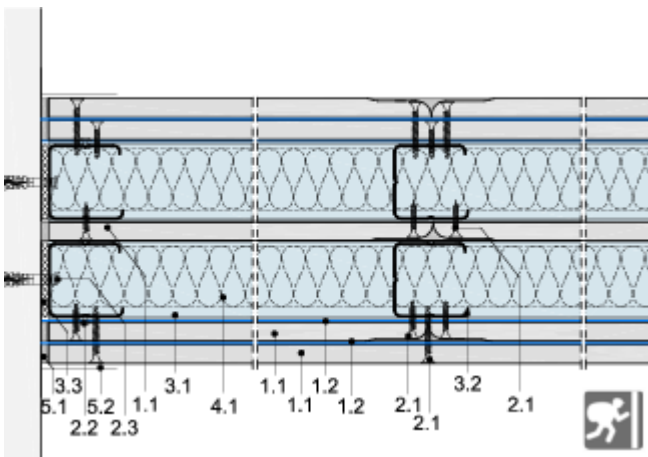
Wandanschluss Einfachständerwand RC 3
